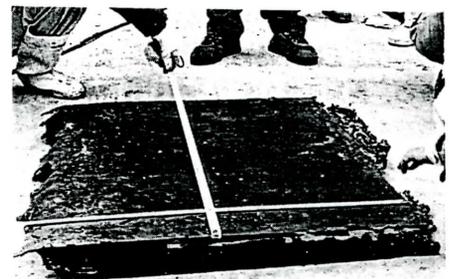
注入翌日に実験土槽から取り出したシリコン系免震材の硬化体
